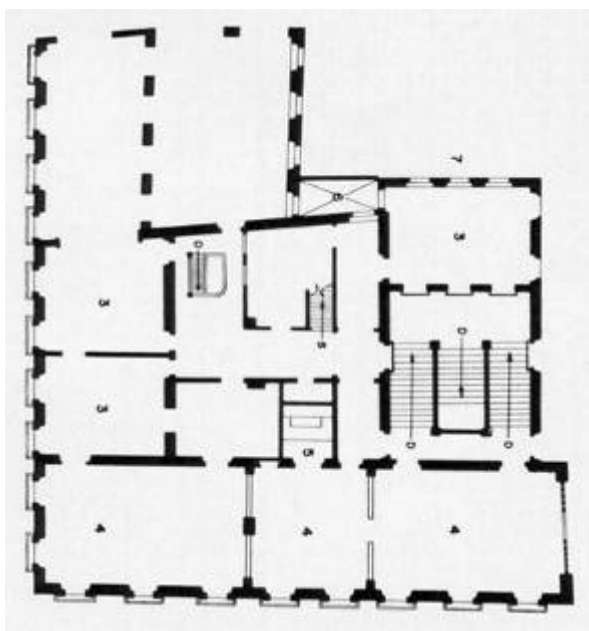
“Estudo para um Museu SPHAN-FNPM-Bahia”, elaborado por Rebouças – planta do pavimento térreo (sem data)
